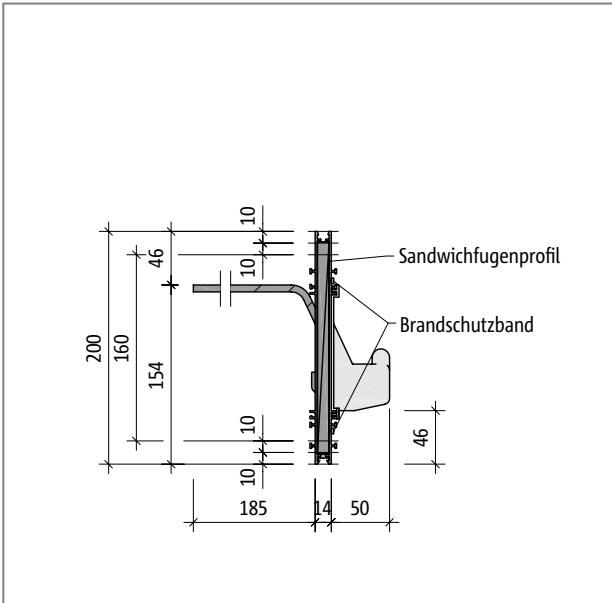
Schöck Tronsole® Typ T: Produktschnitt mit Sandwichfugenprofil in der Grundversion
